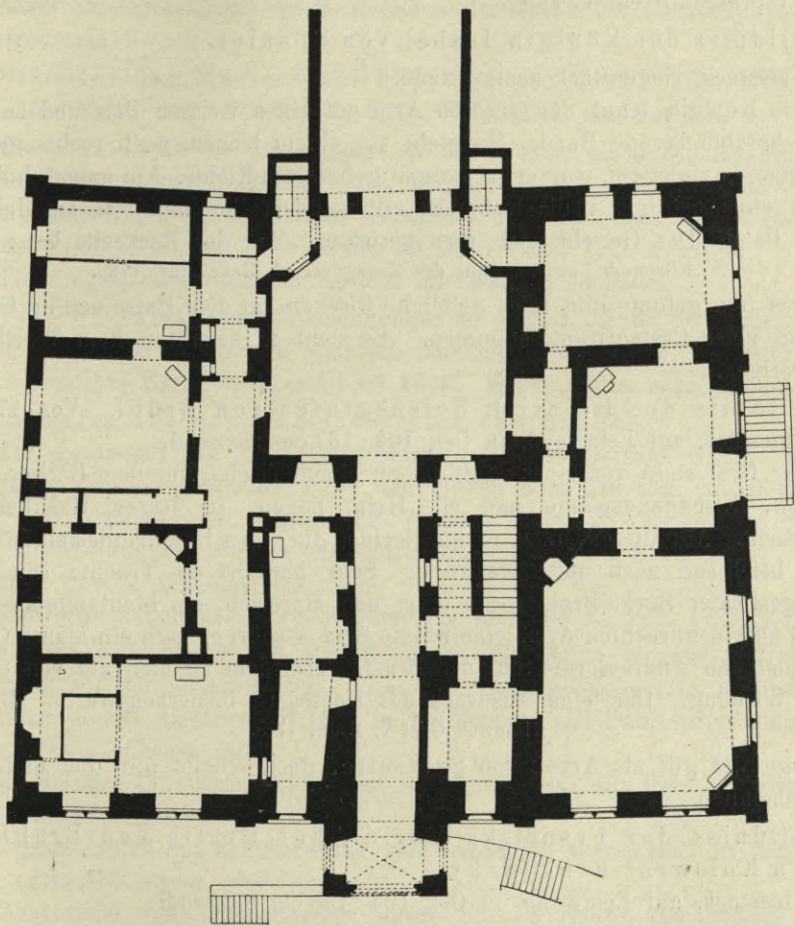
Seifersdorf, Schloss, Grundriss des Erdgeschosses. Zustand nach dem Umbau.
